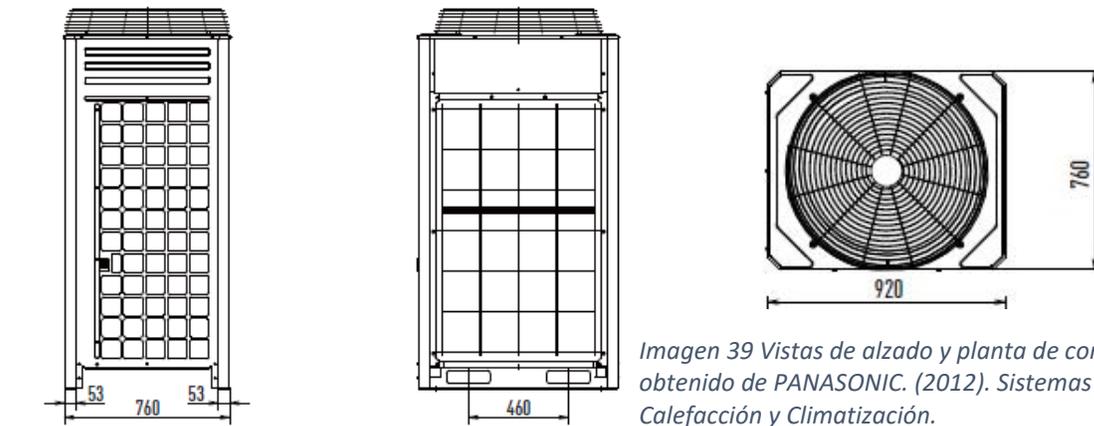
Vistas de alzado y planta de condensadora, obtenido de PANASONIC. (2012). *Sistemas VRF / Sistemas de Calefacción y Climatización.
